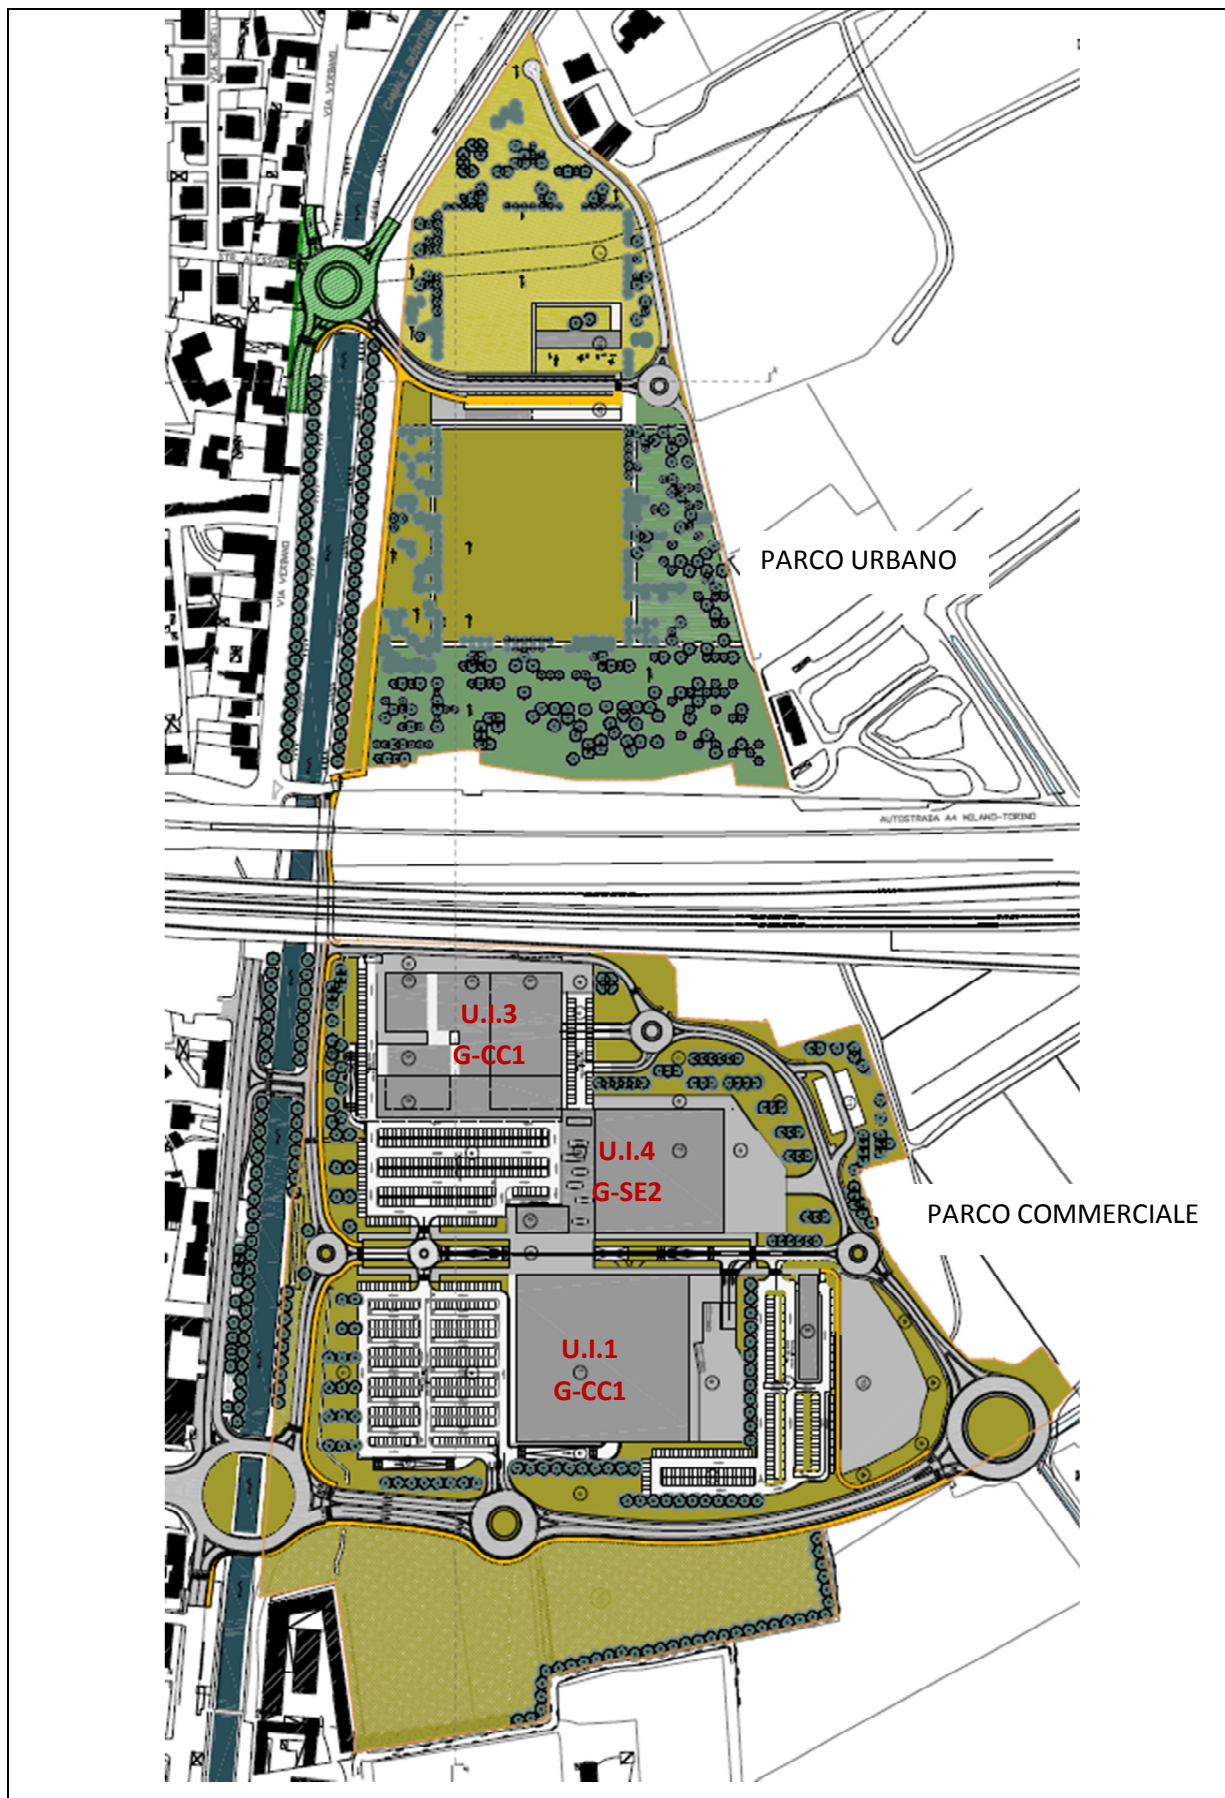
Stralcio planimetrico di progetto di P.P.E (estratto tavola 05 del P.P.E. – planimetria generale) con evidenziate le unità di intervento soggette a Verifica di VIA
